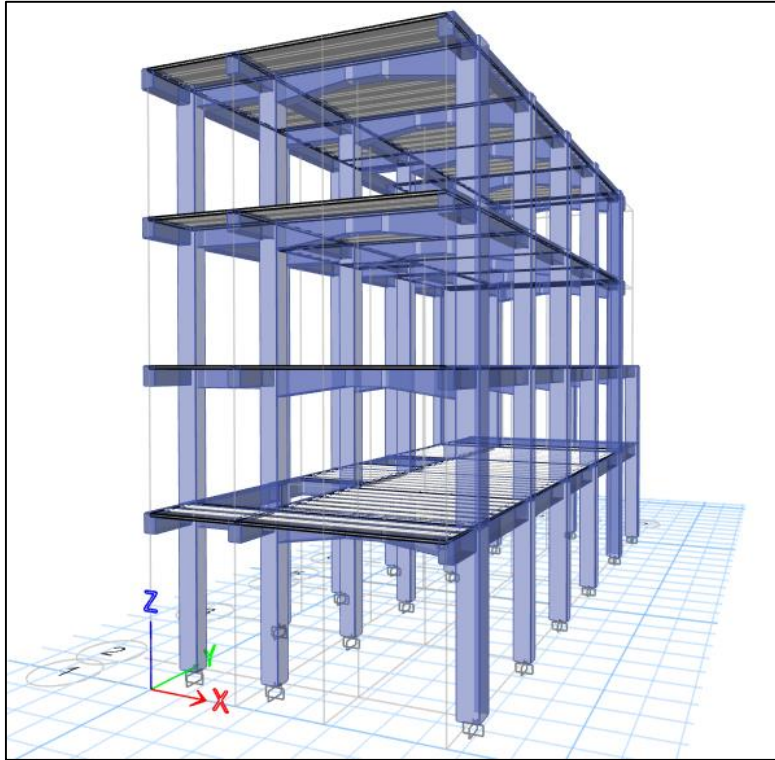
Vista renderizada del modelo 2, vigas de sección variable de 12.65°.
